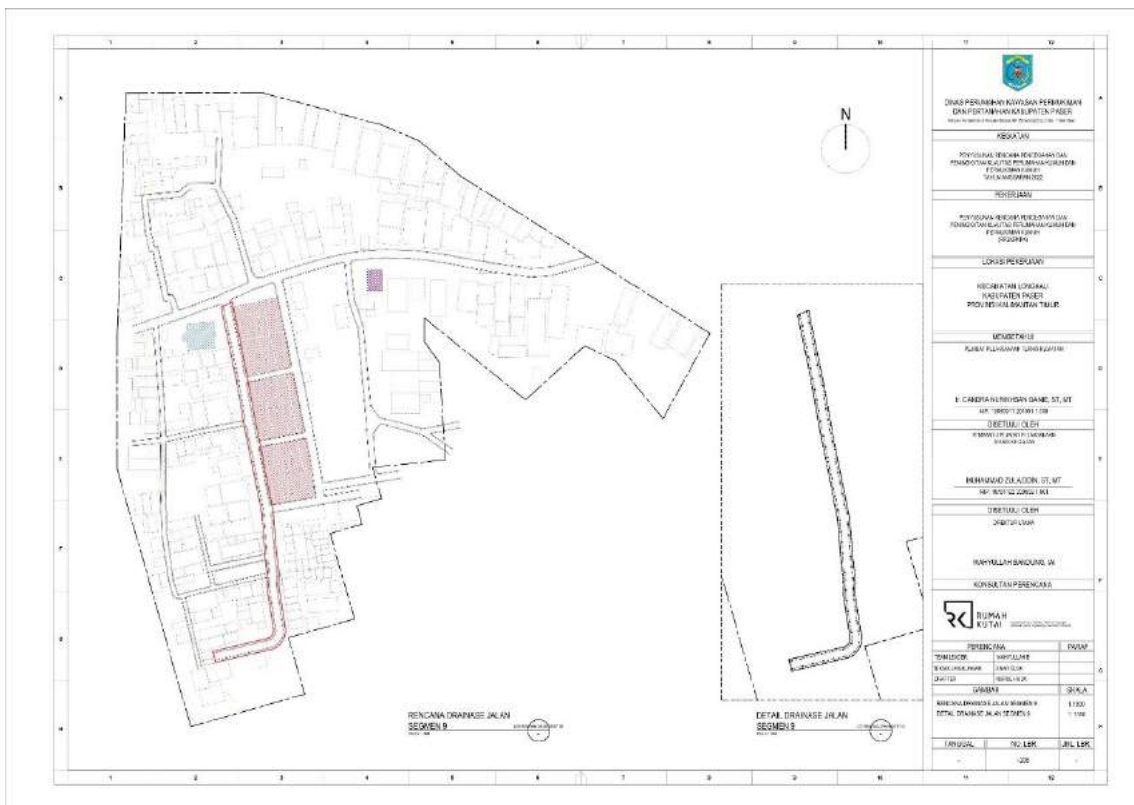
34 Konsep Recana Drainase Segmen 6 RT.02
